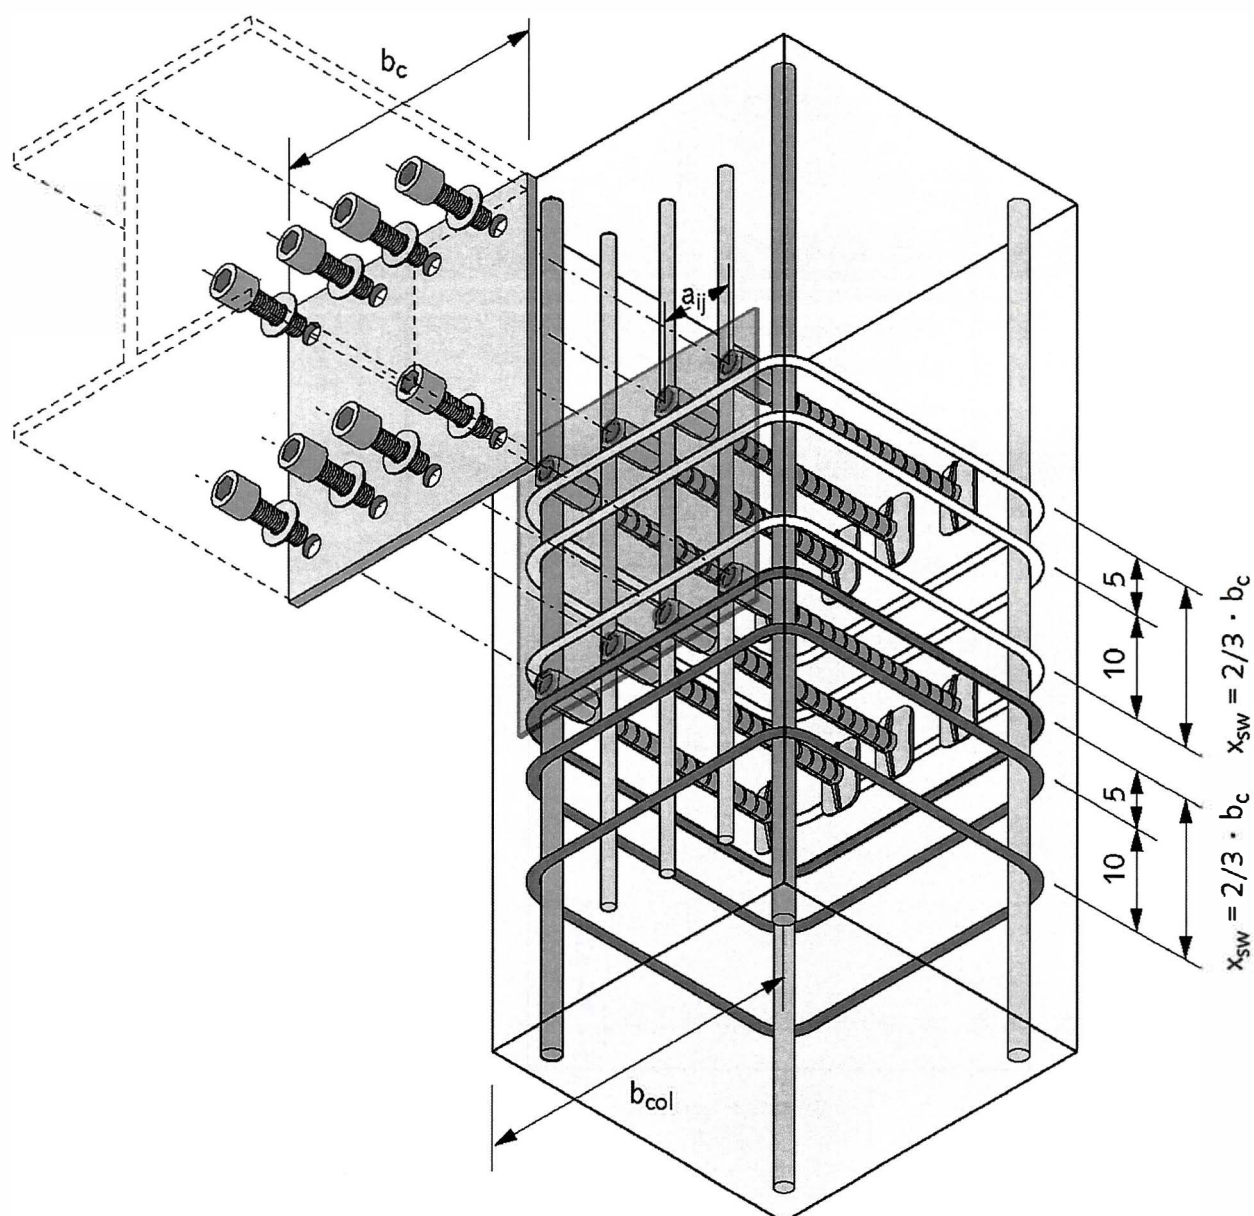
Modele zniszczenia betonu w elemencie żelbetowym w wyniku działania siły poprzecznej w połączeniu elementu żelbetowego z blachą czołową
